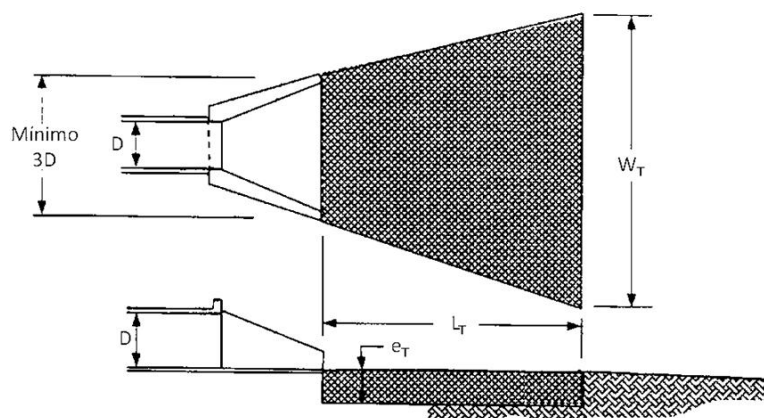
Configuração do tapete de enrocamento para situações de baixa altura de água a jusante (adaptado de TDEC, 2002)
